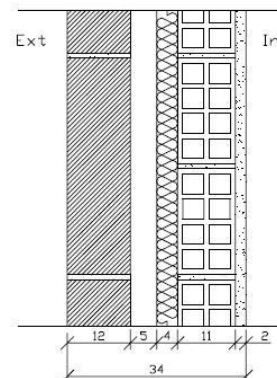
Parede dupla em pedra aparente e tijolo furado com isolamento na caixa-de-ar.
